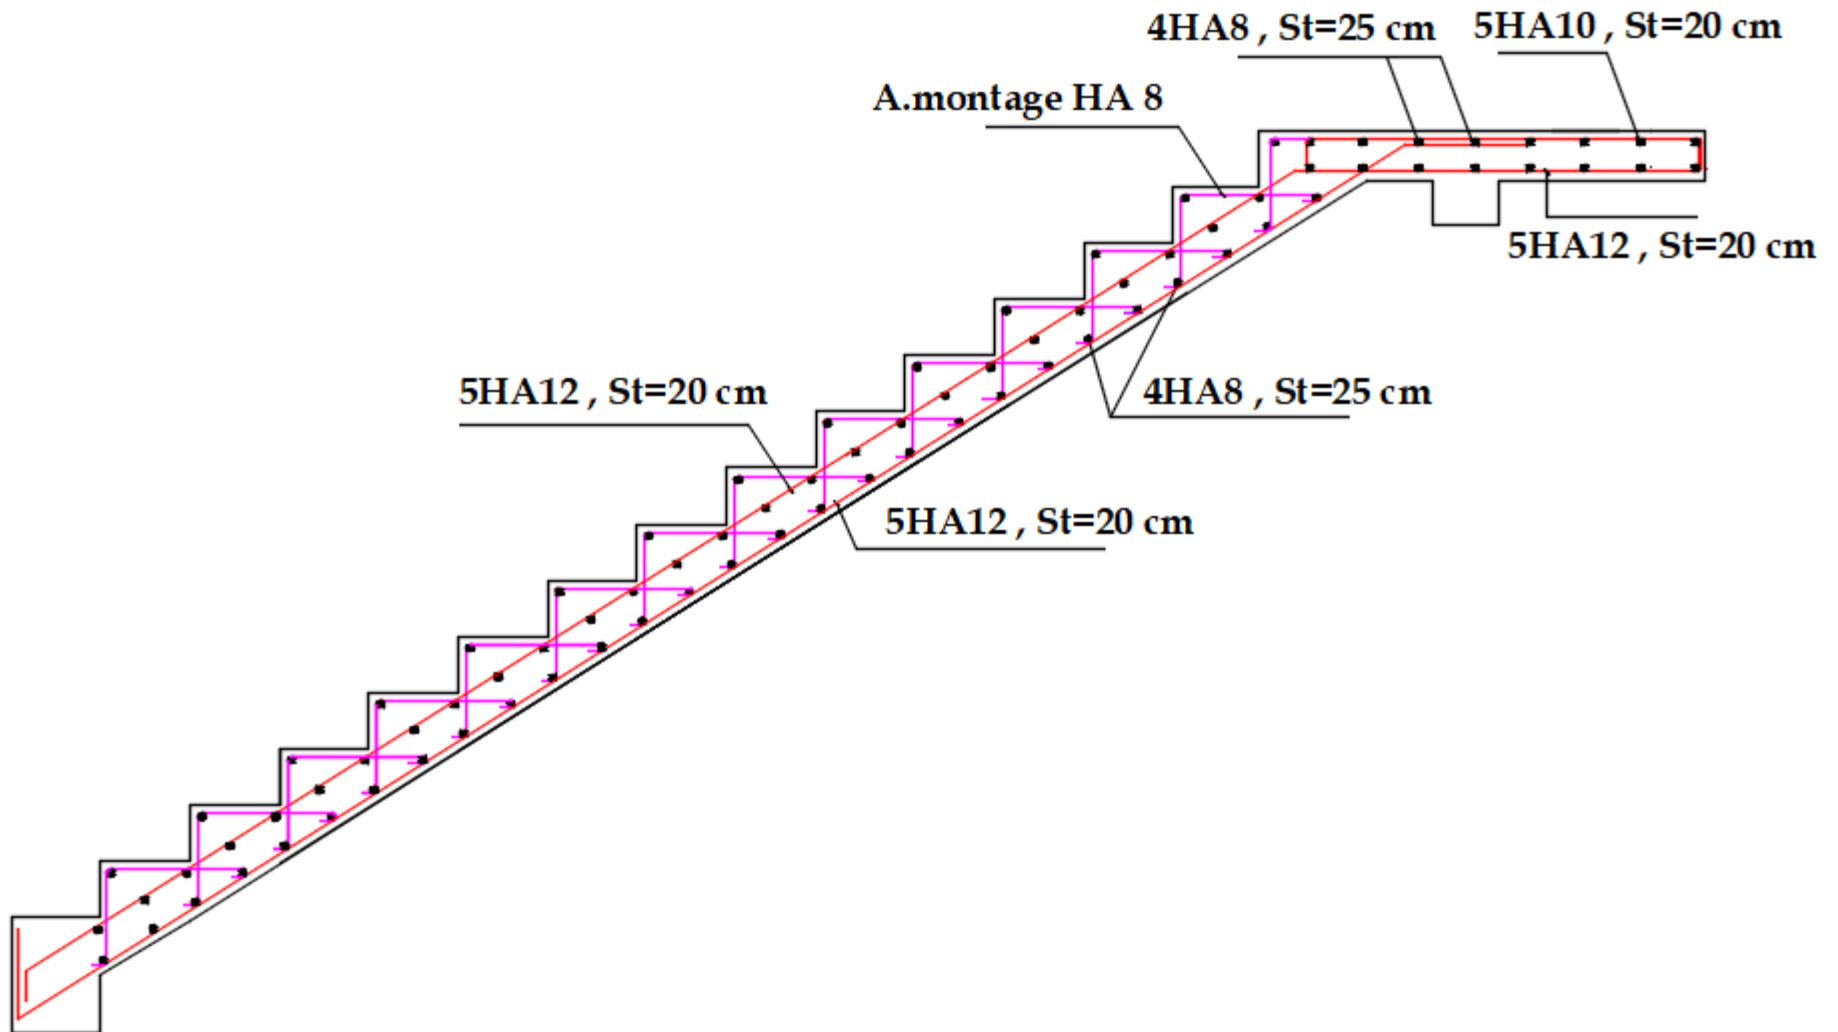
Plan de ferrailage de l'escalier de RDC
